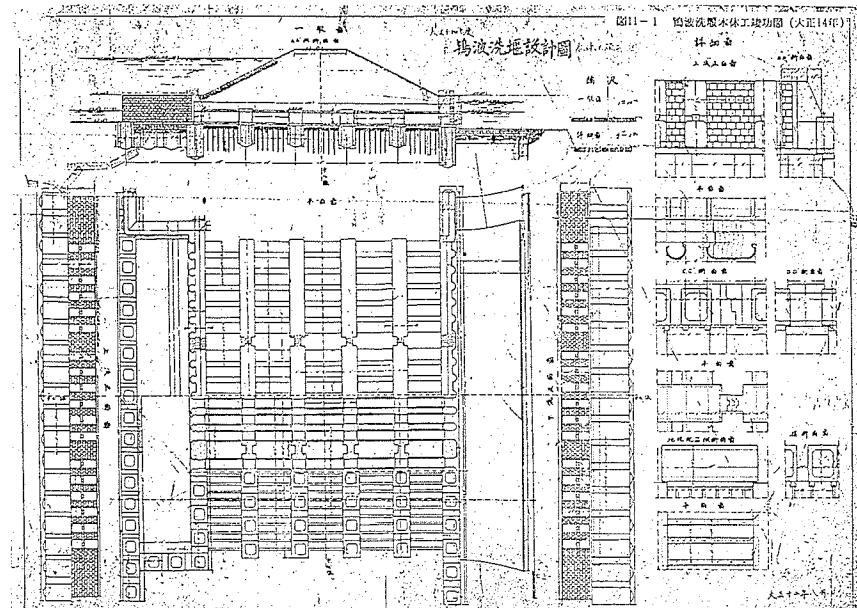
鴨波洗堰基礎平面図(大正12, 13, 14年) (所蔵: 北上川下流工事事務所)
